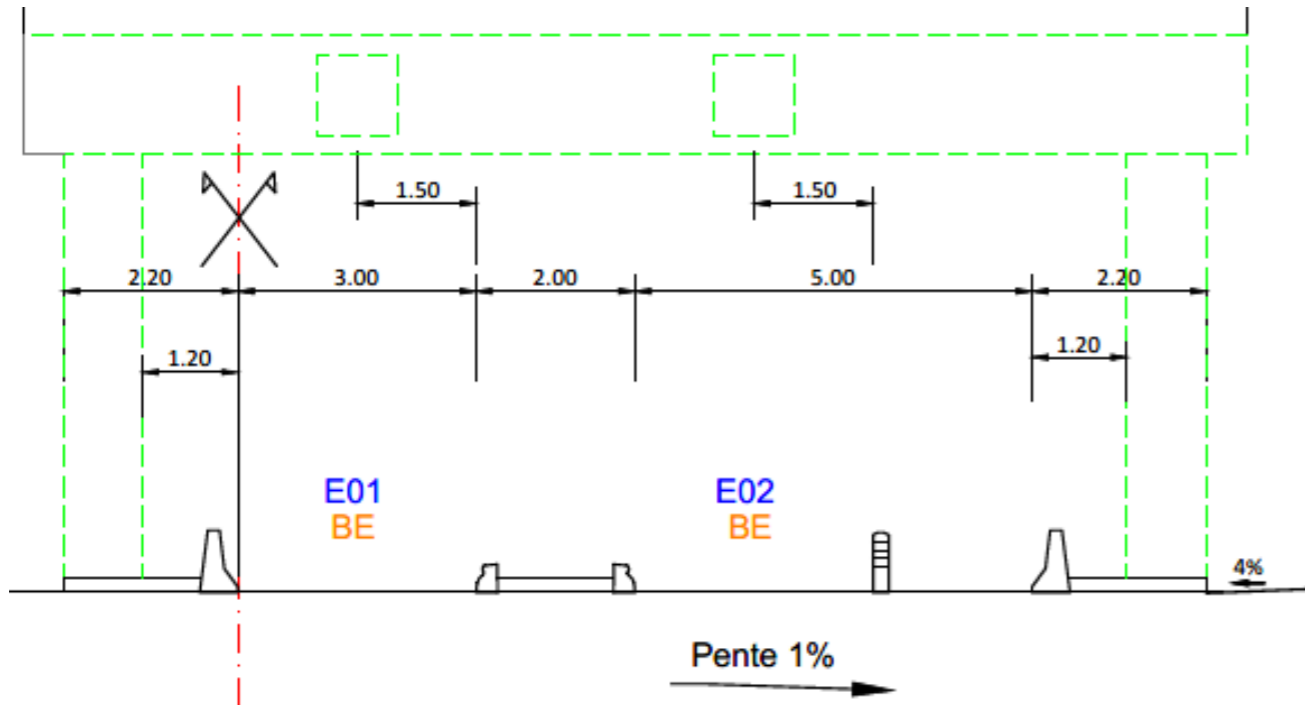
PROFIL EN TRAVERS SUR GARE DE PÉAGE
